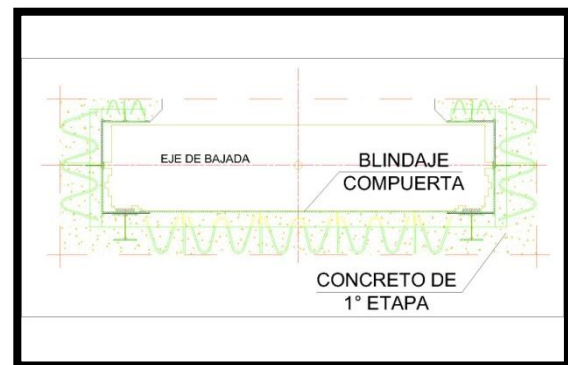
Sección transversal con blindaje metalmecánico. (Sección G-G)
